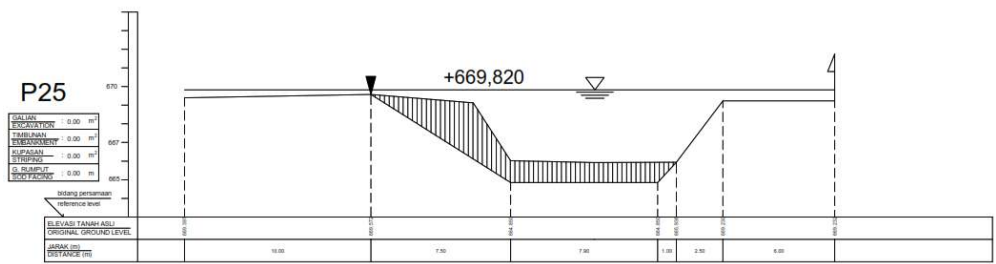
Contoh Long Section Perencanaan Normalisasi Sungai Cirasea
